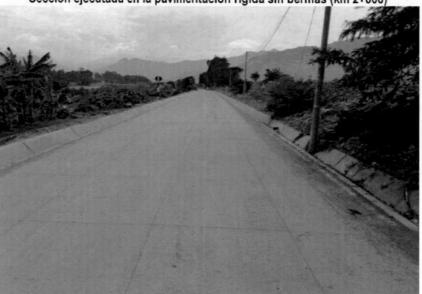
Sección ejecutada en la pavimentación rígida sin bermas (km 2+000)
